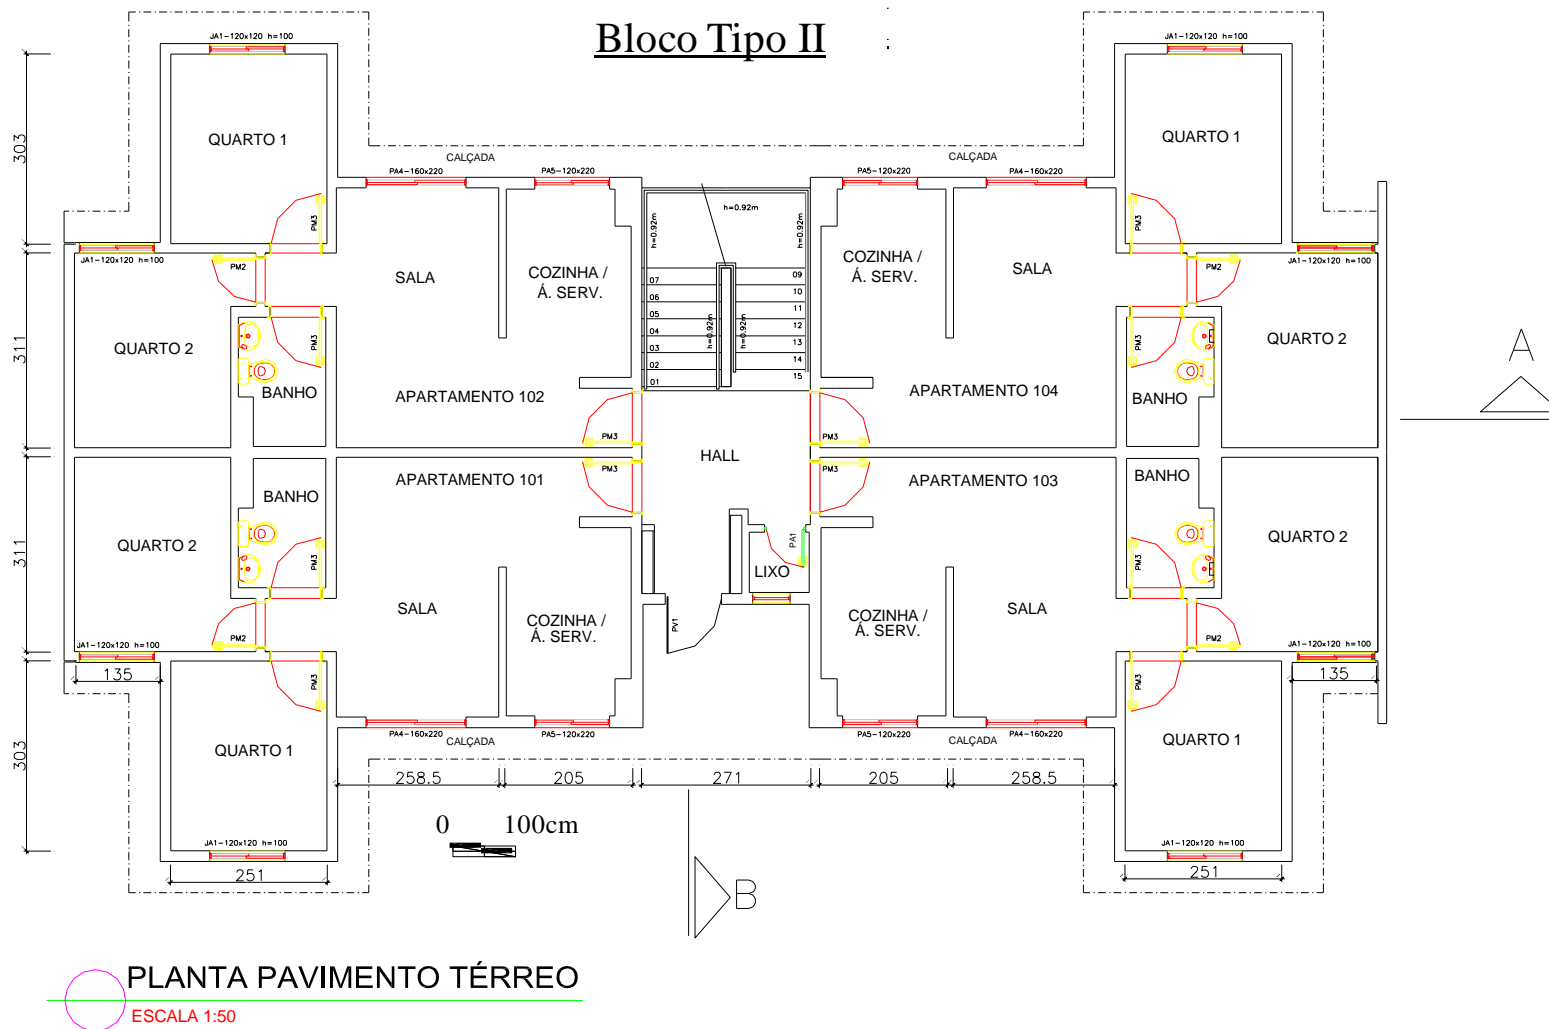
Plano de arquitetura em planta para o Bloco do tipo II.
